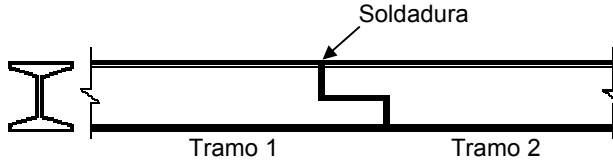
Soldadura de un pilote formado por un perfil estructural
